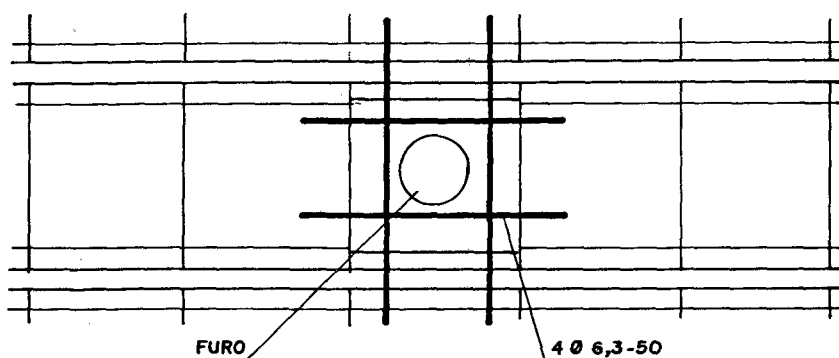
REFORÇO NOS FUROS DA LAJE
